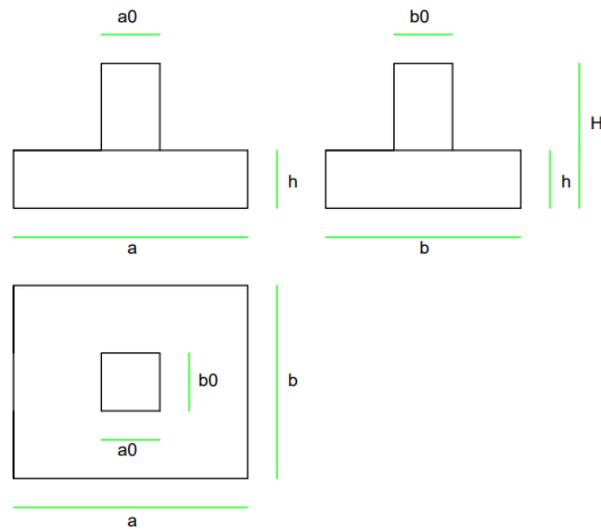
Esquema alzado, planta y perfil de una zapata. Fuente: Elaboración propia.
